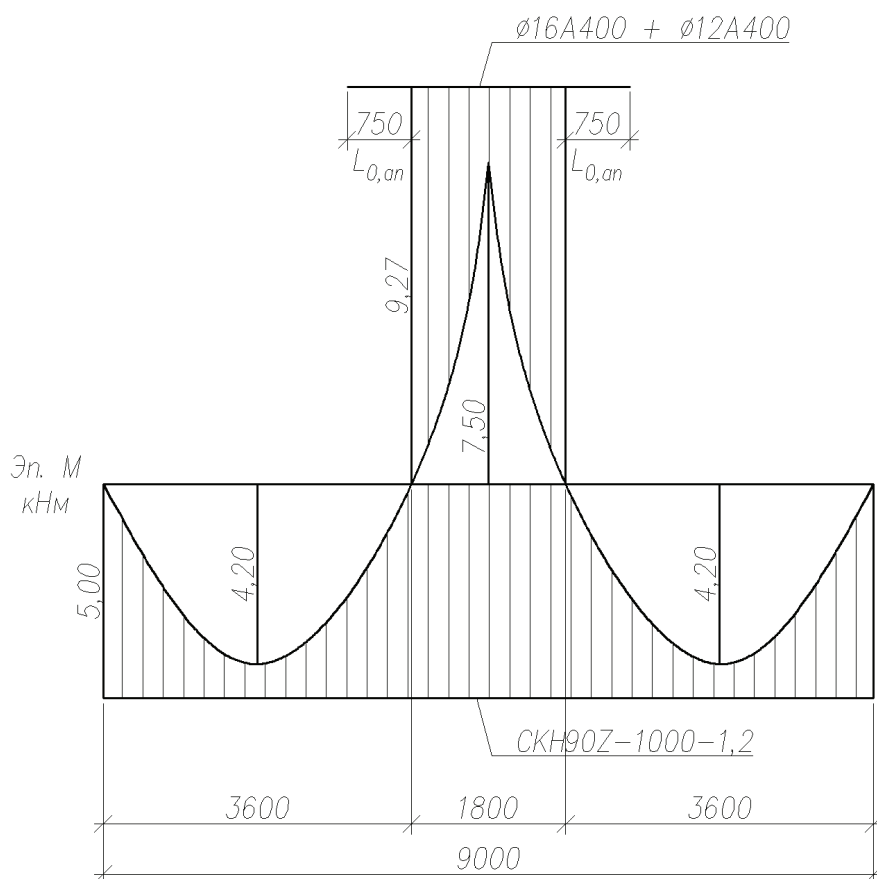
Эпюра материалов одного ребра плиты для 2-го варианта перекрытия
